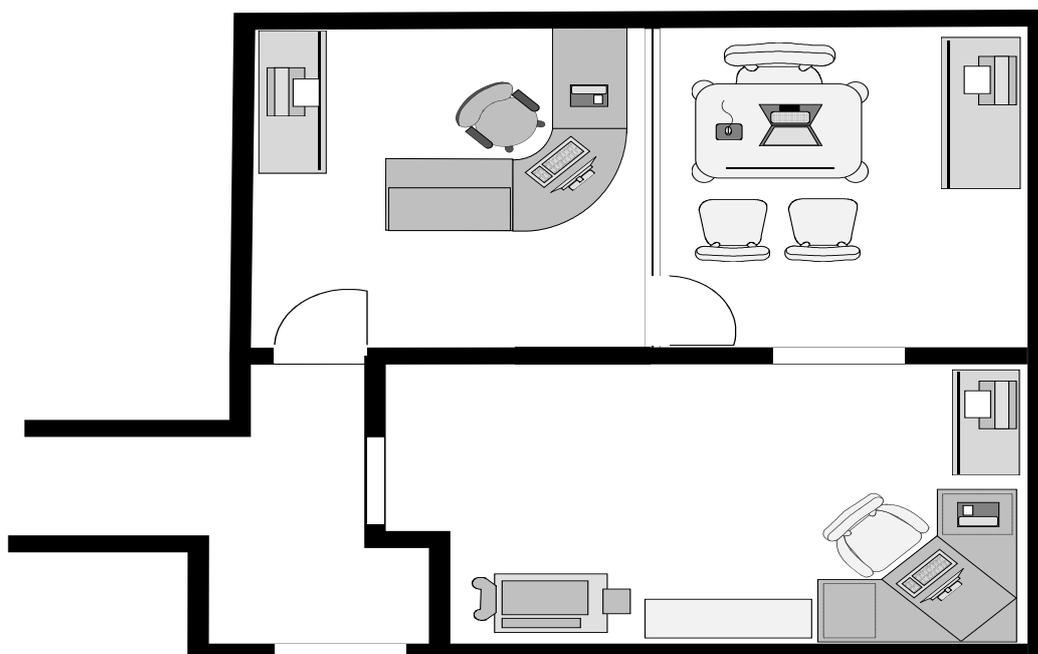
Planta baixa do *layout* proposto para a Empresa Escola
